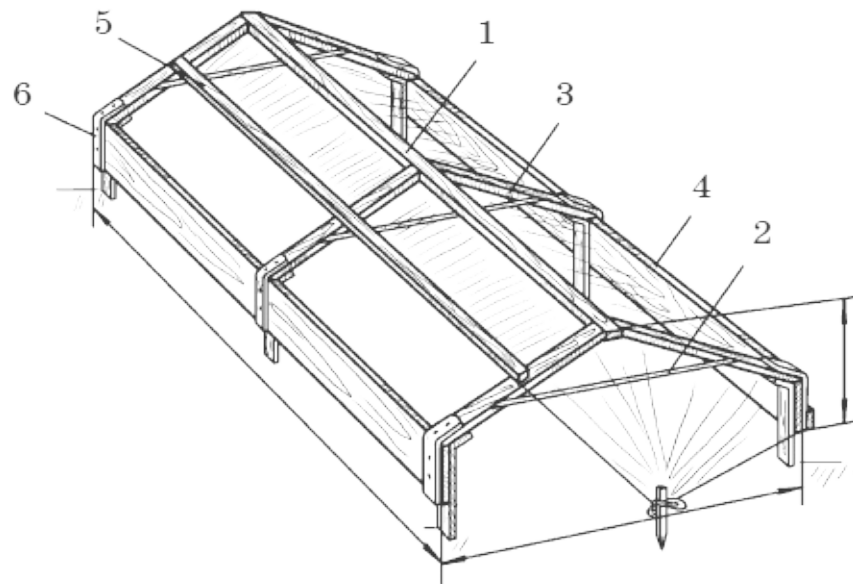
Разборно-передвижной парник: 1 — коньковый брус; 2 — стяжка; 3 — строительный брус; 4 — бортовая доска; 5 — бобина с пленкой; 6 — соединительная скоба
